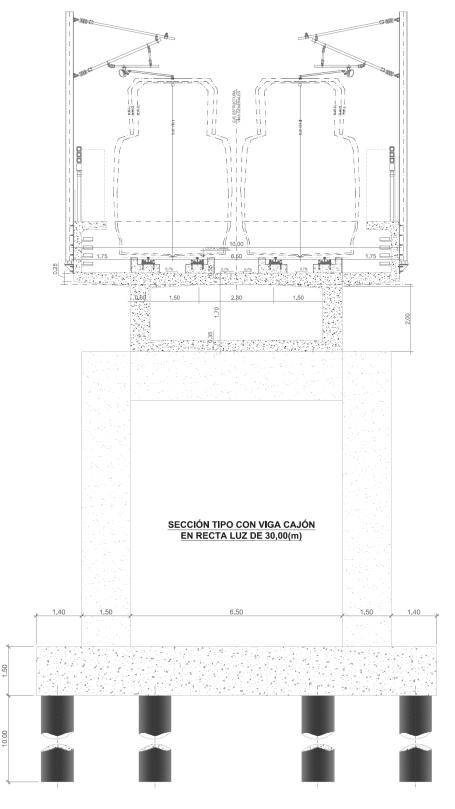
Sección estructural tipo para viaducto con dos carriles y luz de 30 m
